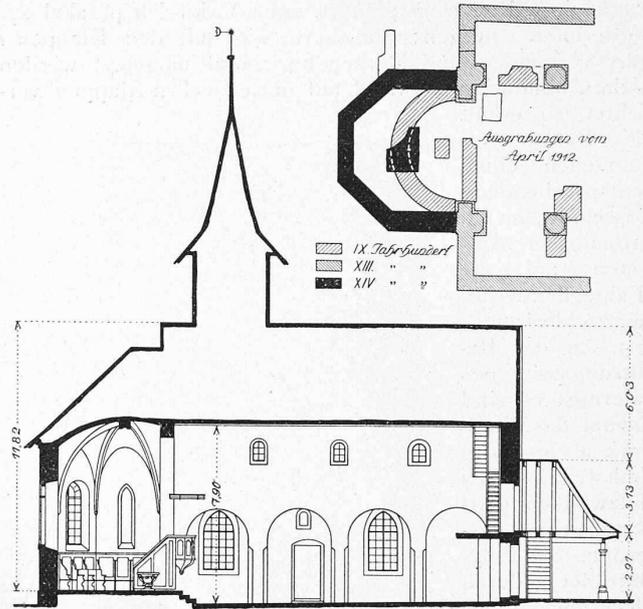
u. 4. Grundriss u. Schnitt. — Abb. 5. Fundamente. — 1 : 400.
